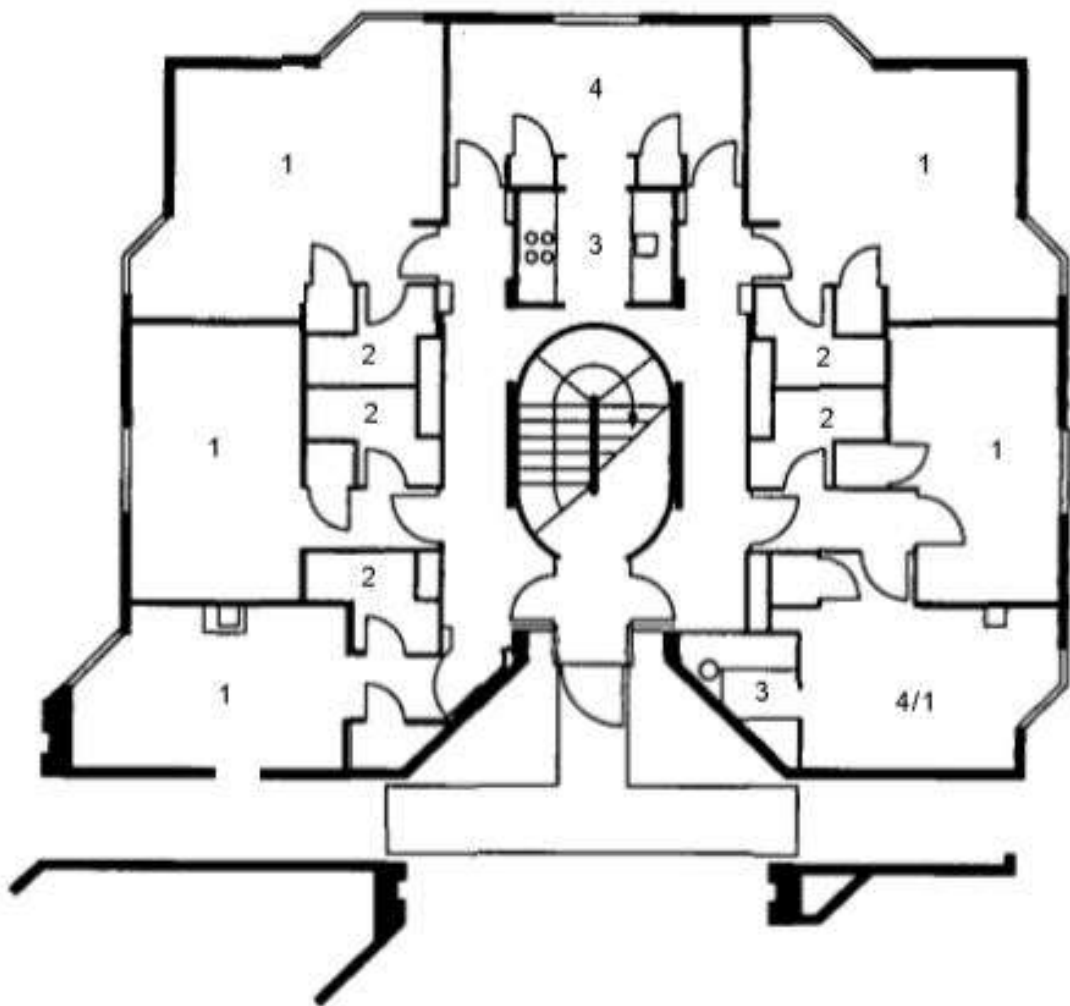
Planta do Pavimento Térreo. Balliol College, Reino Unido.
